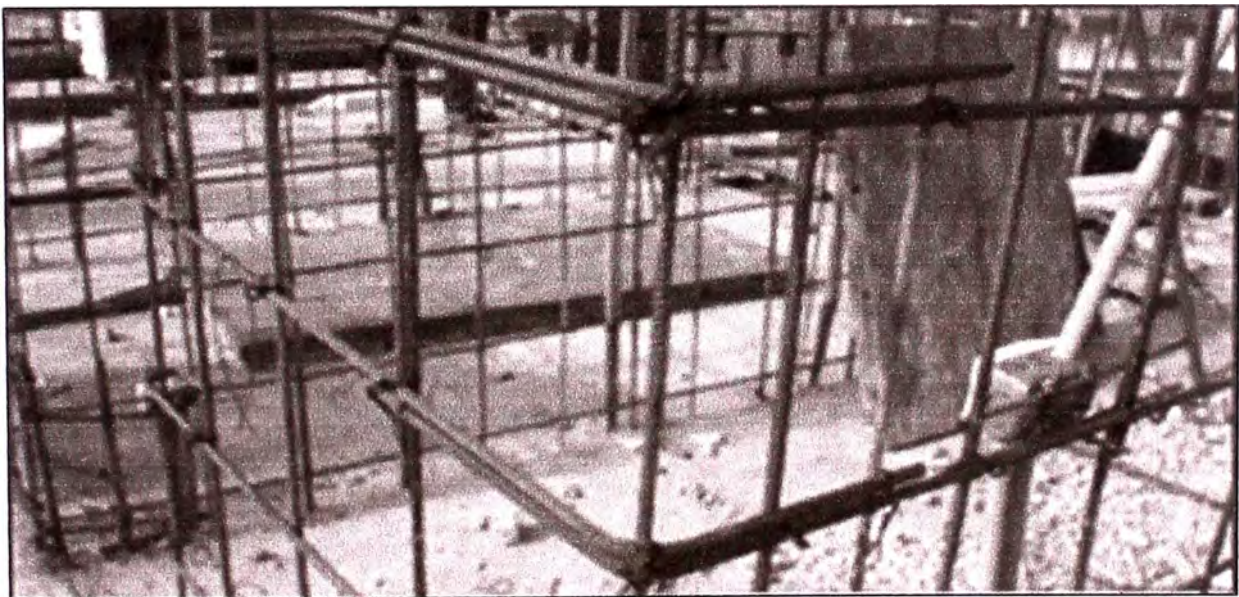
Empalmes horizontal de acero en esquina - SMDL
